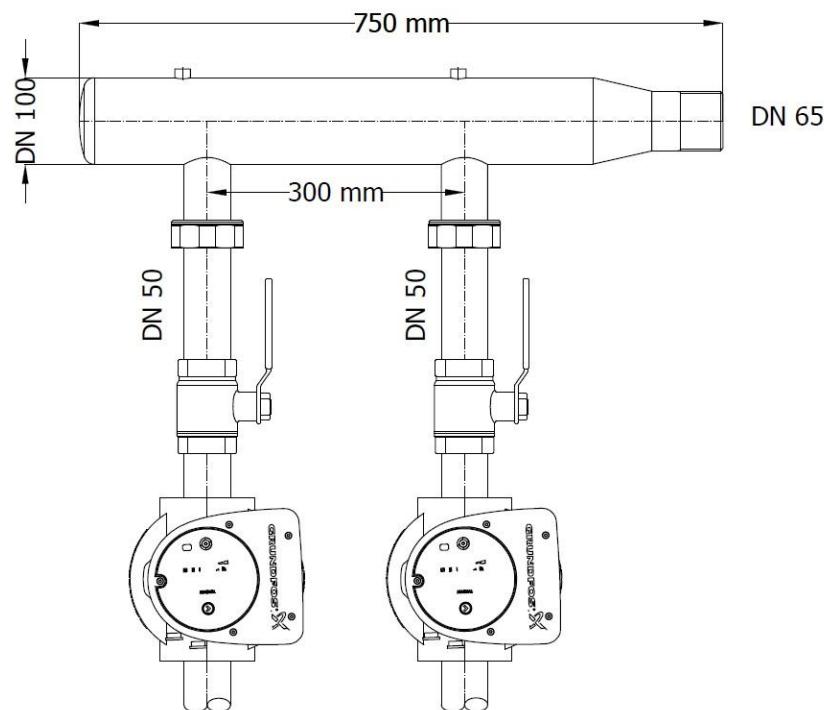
Shema spajanja hidrauličke skretnice^[11]
